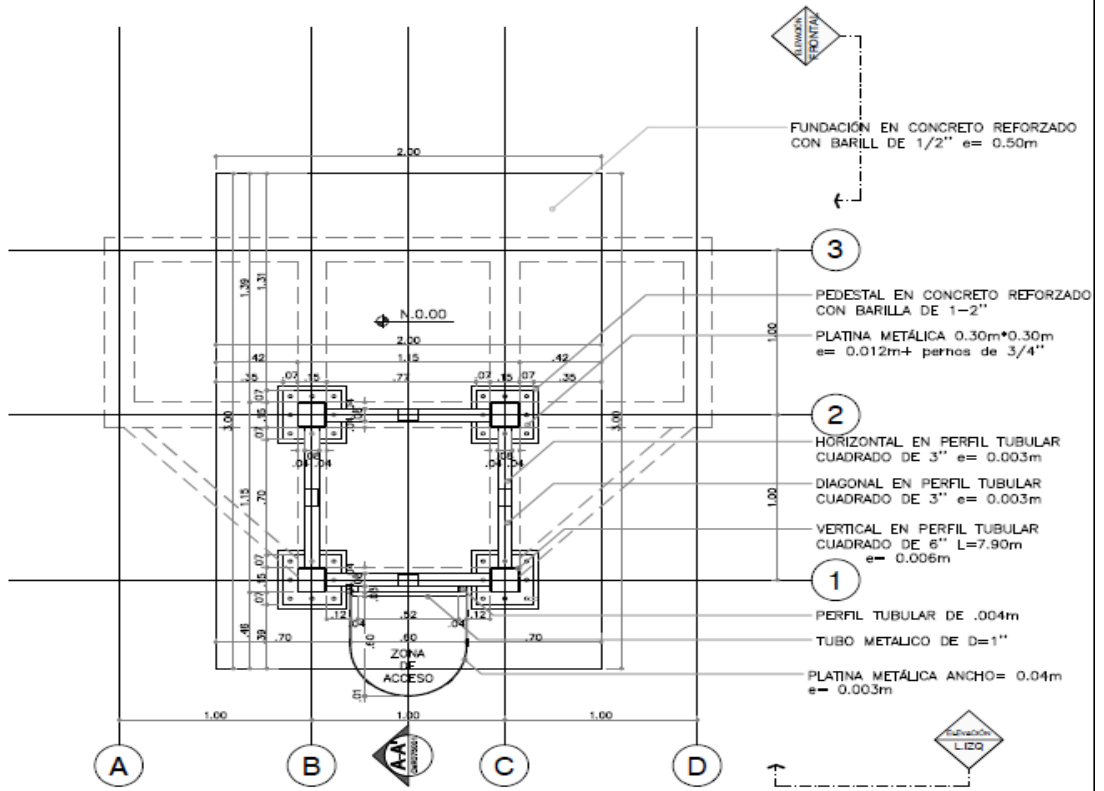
Planta/nivel base estructural(Andres Hoyos, 2015)
